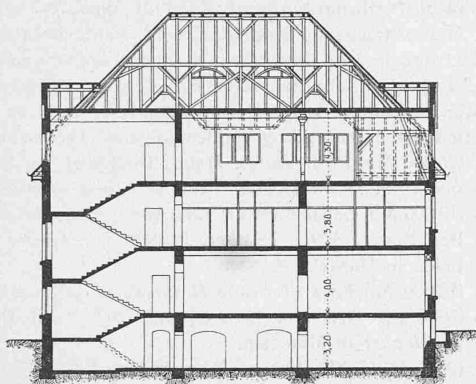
und 3. Schnitt und Grundrisse. — 1:400.
